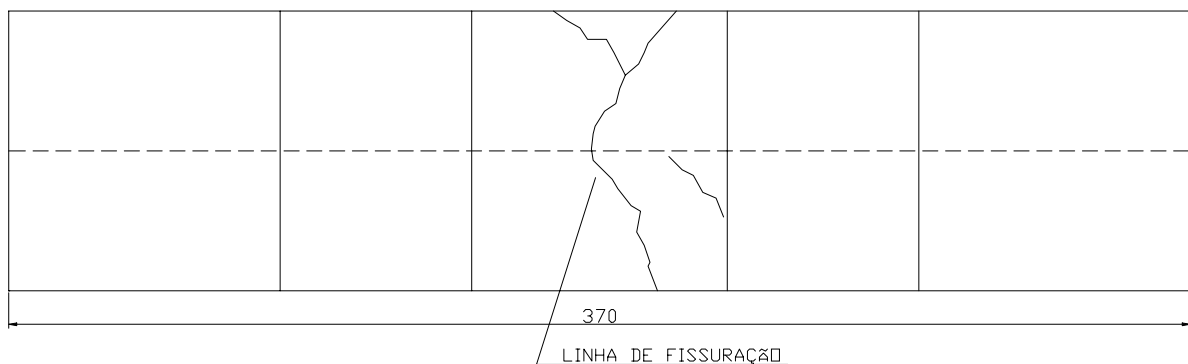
Fissuras na face inferior da pré-laje, modelos 4 e 6.
